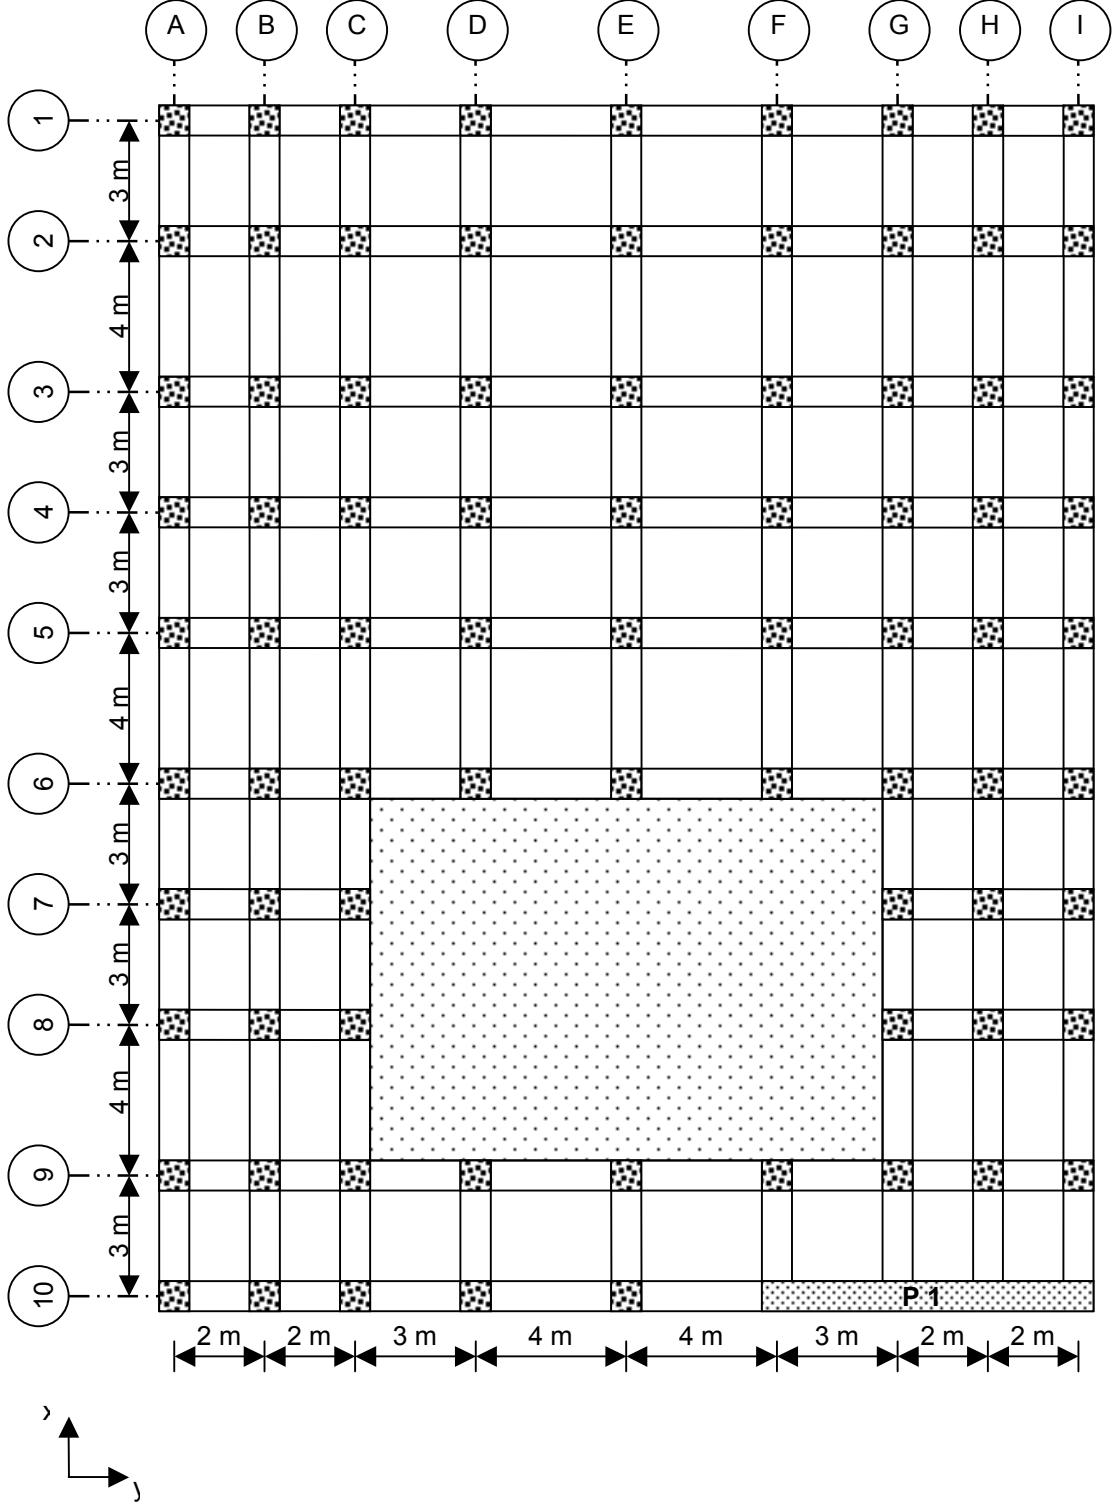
Örnek 5.7'nin kat kalıp planı
